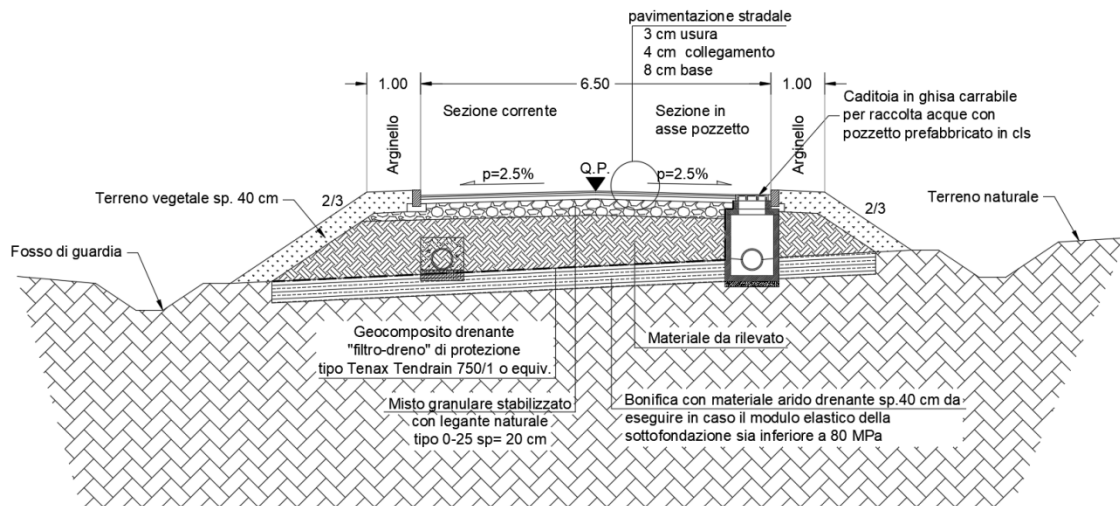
Sezione Tipo Strada Accesso Cantiere Forch
